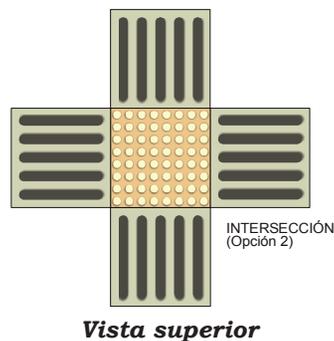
c Disposiciones (Opción 2)
